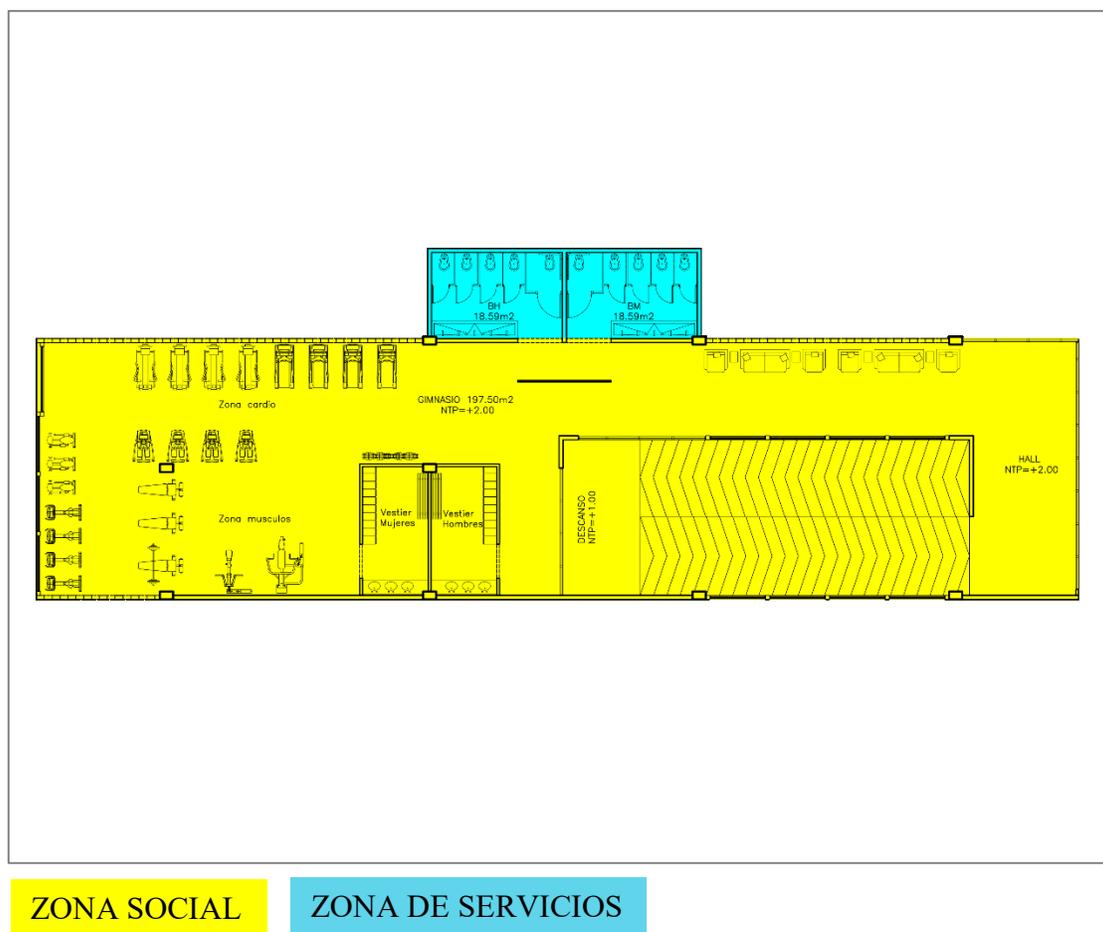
Zonificación Planta 1 (Rubiano, 2020)
